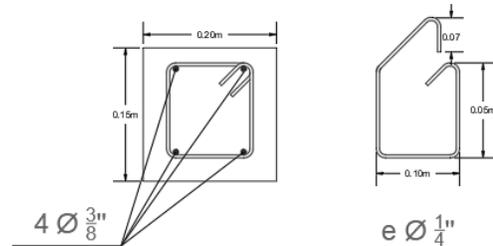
Detalle de refuerzo. Magali Rozo.
